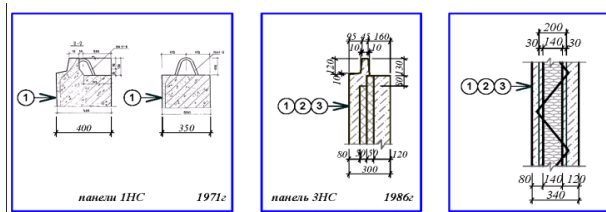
Эволюция конструкции стеновых панелей / Evolution design wall panels
